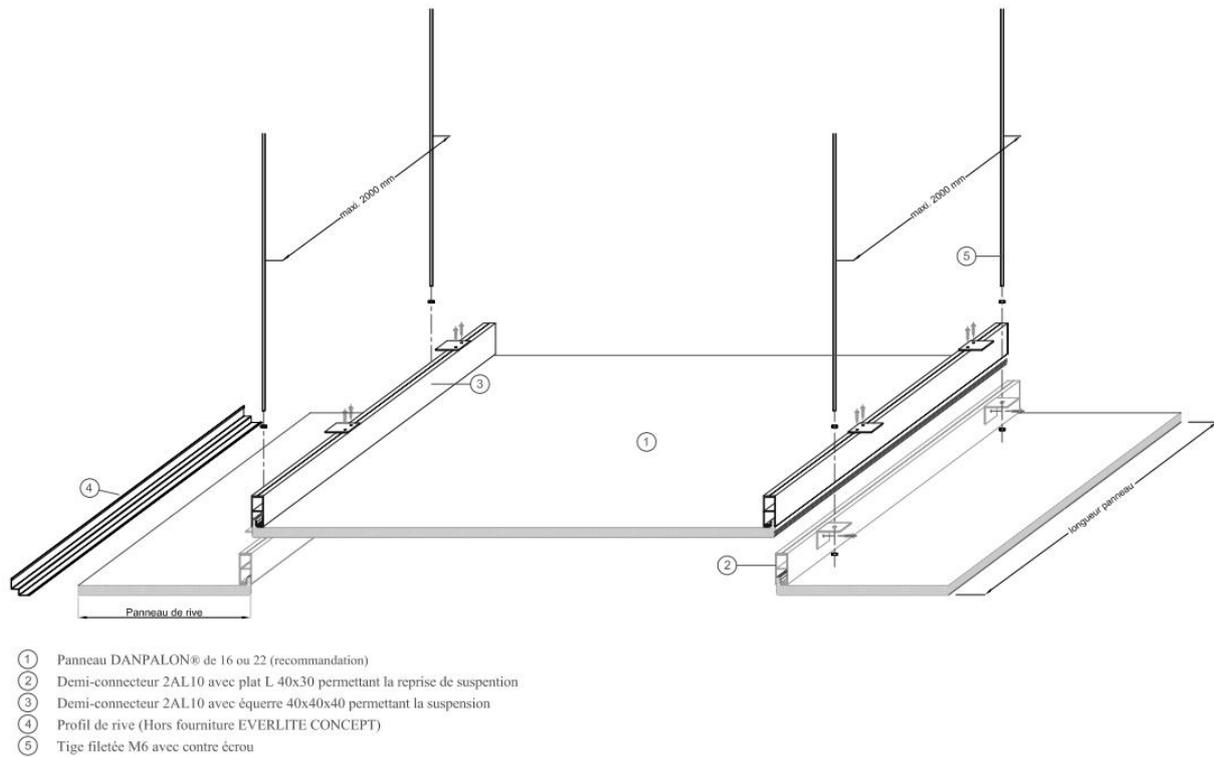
Trappe d'accès – Système DANPALON® application plafond suspendu
